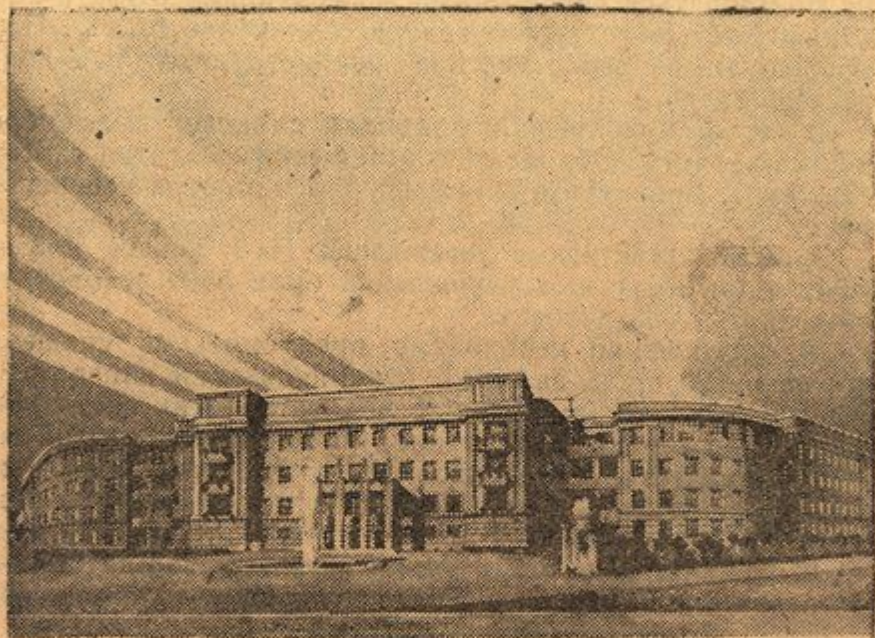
Проект реконструкции здания Мединститута (перспектива фасада).
